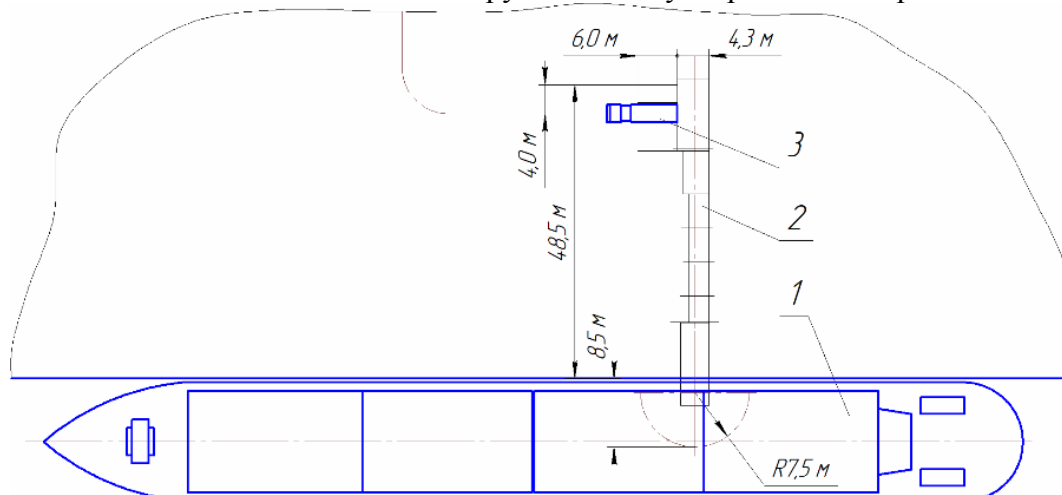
План перегрузочной площадки МЛ6 на МП5: 1 – сухогрузное судно; 2 – погрузочный комплекс КПЛН-26АМ; 3 – АТС
